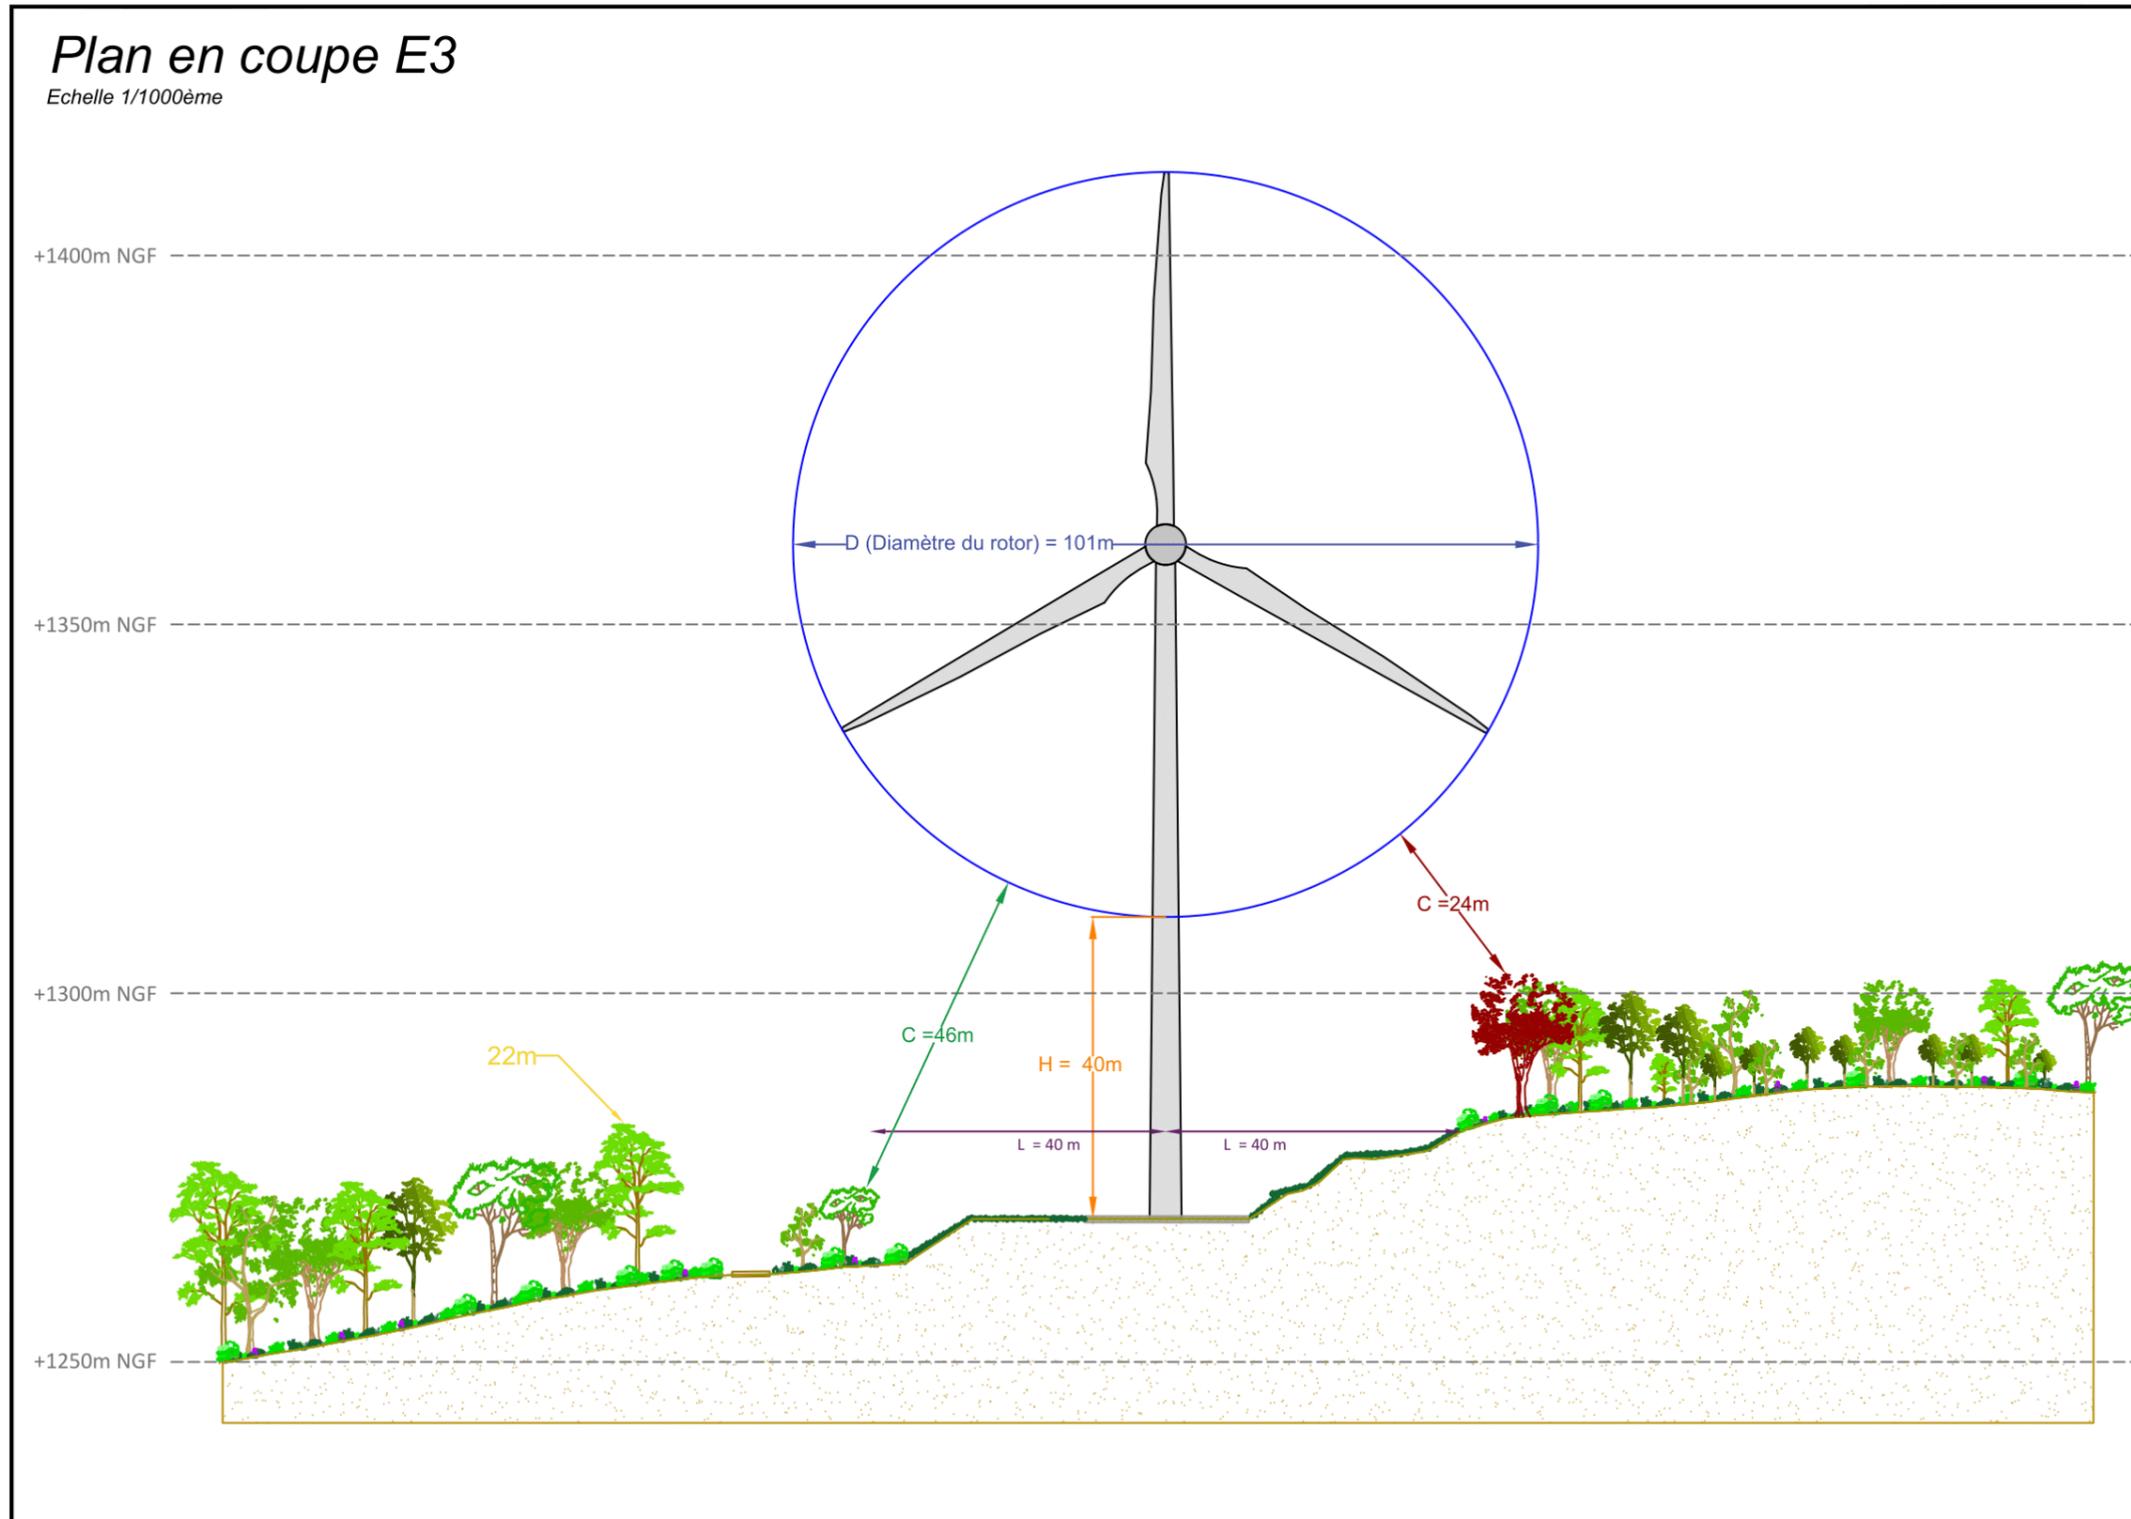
Plan de coupe et distance aux lisières (éolienne E3)
